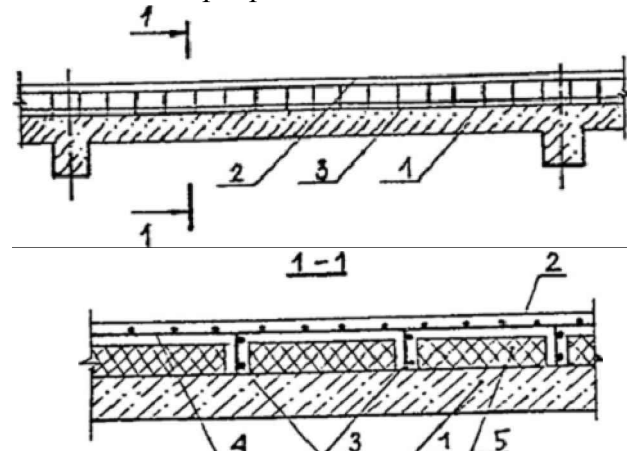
Підсилення плити перекриття нарощуванням зверху з пустототворювачами: 1 – плита перекриття, що підсилюється; 2 – монолітна ребриста плита нарощування; 3 – арматурні каркаси нарощування; 4 – арматурні сітки нарощування; 5 – пустототворювач (пінопласт, піноплекс тощо)
